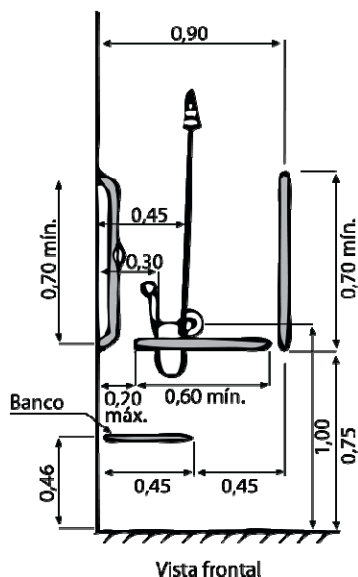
Boxe para chuveiro com barras vertical e horizontal – Exemplo
